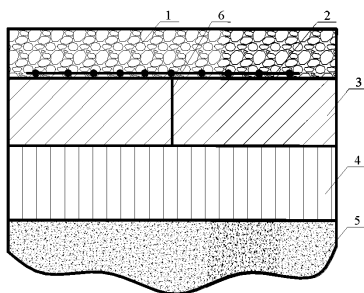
Усиление цементобетонного покрытия асфальтобетоном с использованием геосинтетических материалов без устройства выравнивающего слоя:
